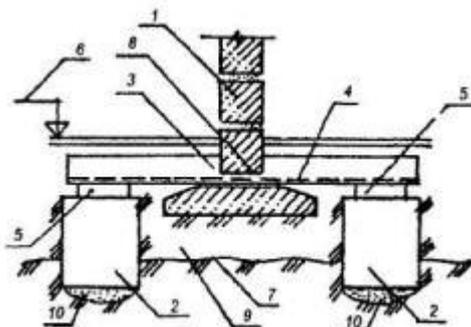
1 - сборный ленточный фундамент; 2 - дополнительные опоры-фундаменты; 3 - монолитные железобетонные балки усиления; 4 - рабочая арматура балок; 5 - подкладки; 6 - отметка пола подвала; 7 - слой грунта с наибольшей несущей способностью; 8 - отверстие между фундаментными блоками для пропуска рабочей арматуры балок; 9 - слой слабого грунта; 10 - зоны уплотненного грунта.
